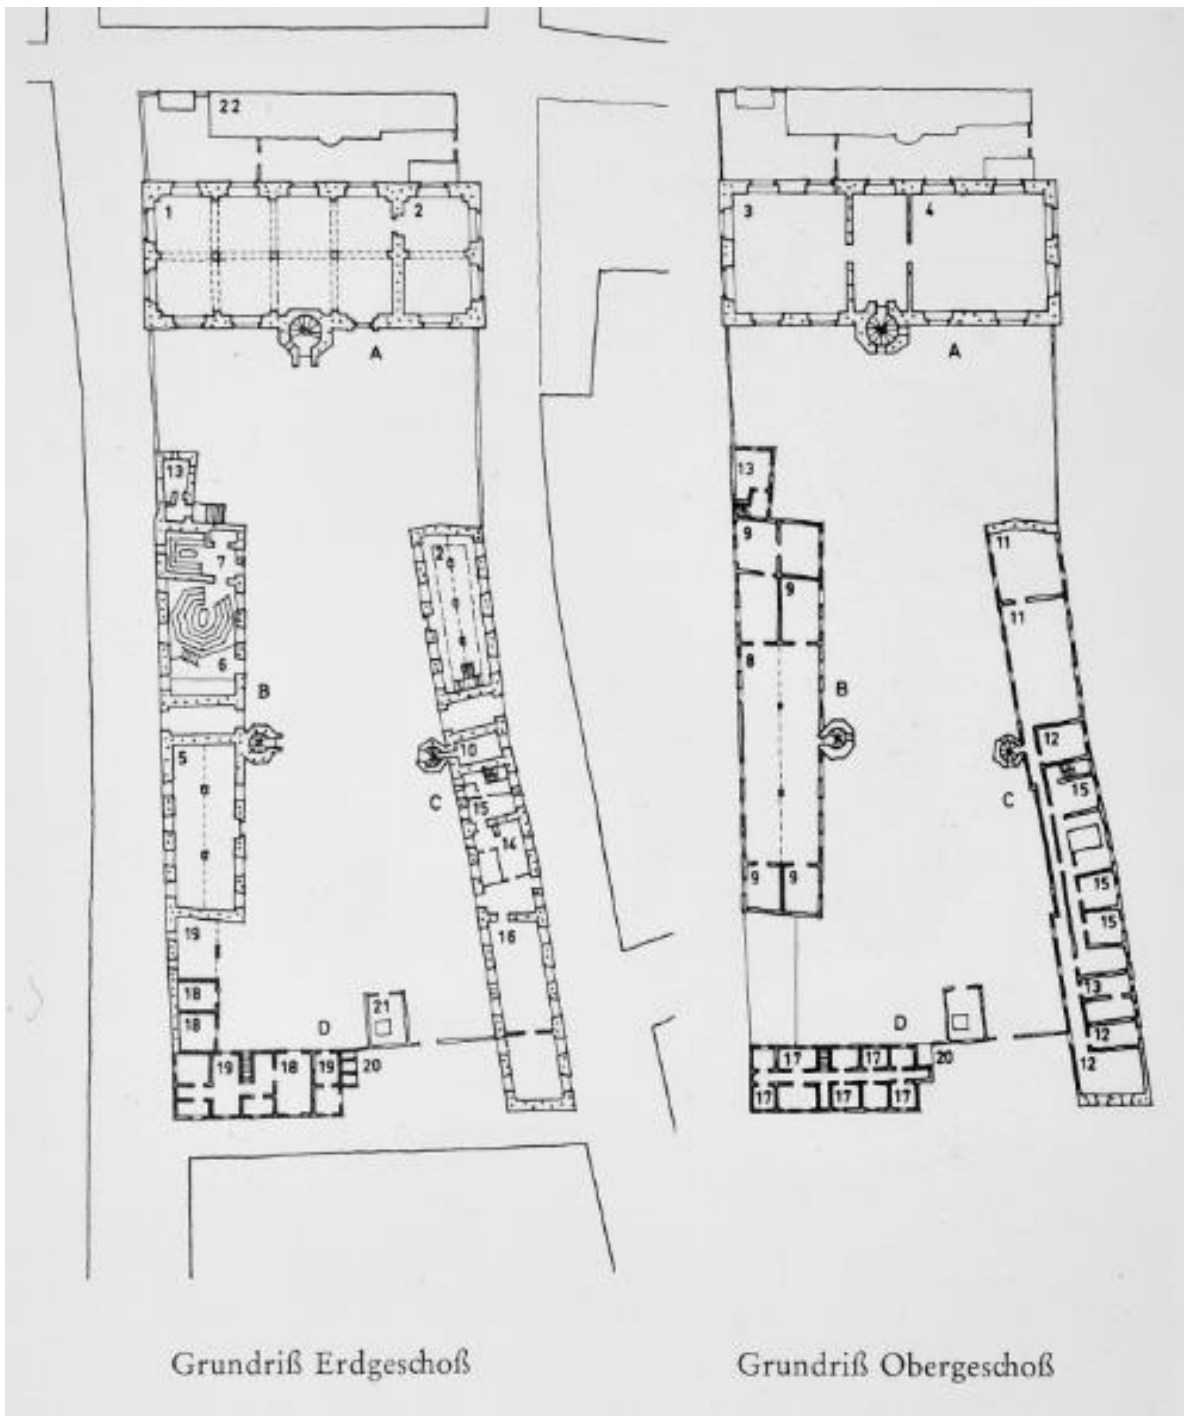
Academia Julia, Grundriss, aus: Konrad Rückbrod: *Universität und Kollegium. Baugeschichte und Bautyp*, Darmstadt 1977
